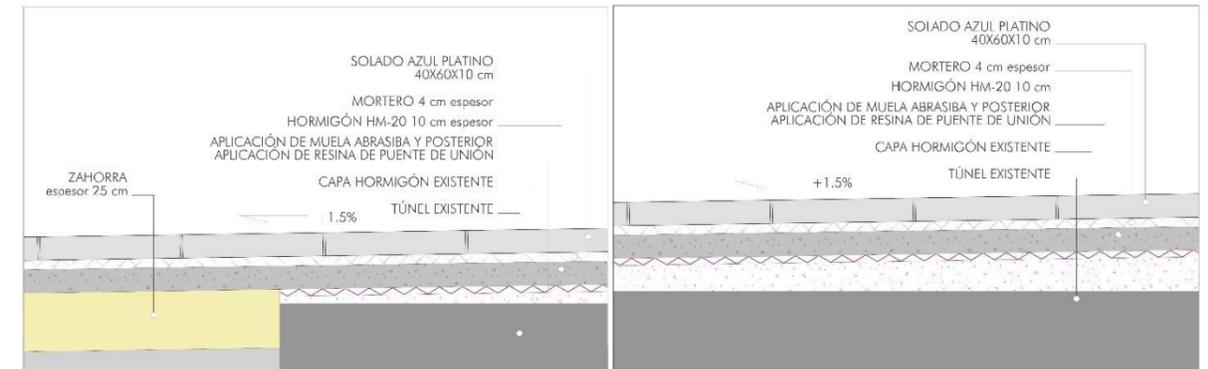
Imagen de la pavimentación en la zona fuera del túnel (izquierda) y sobre el túnel (derecha).
